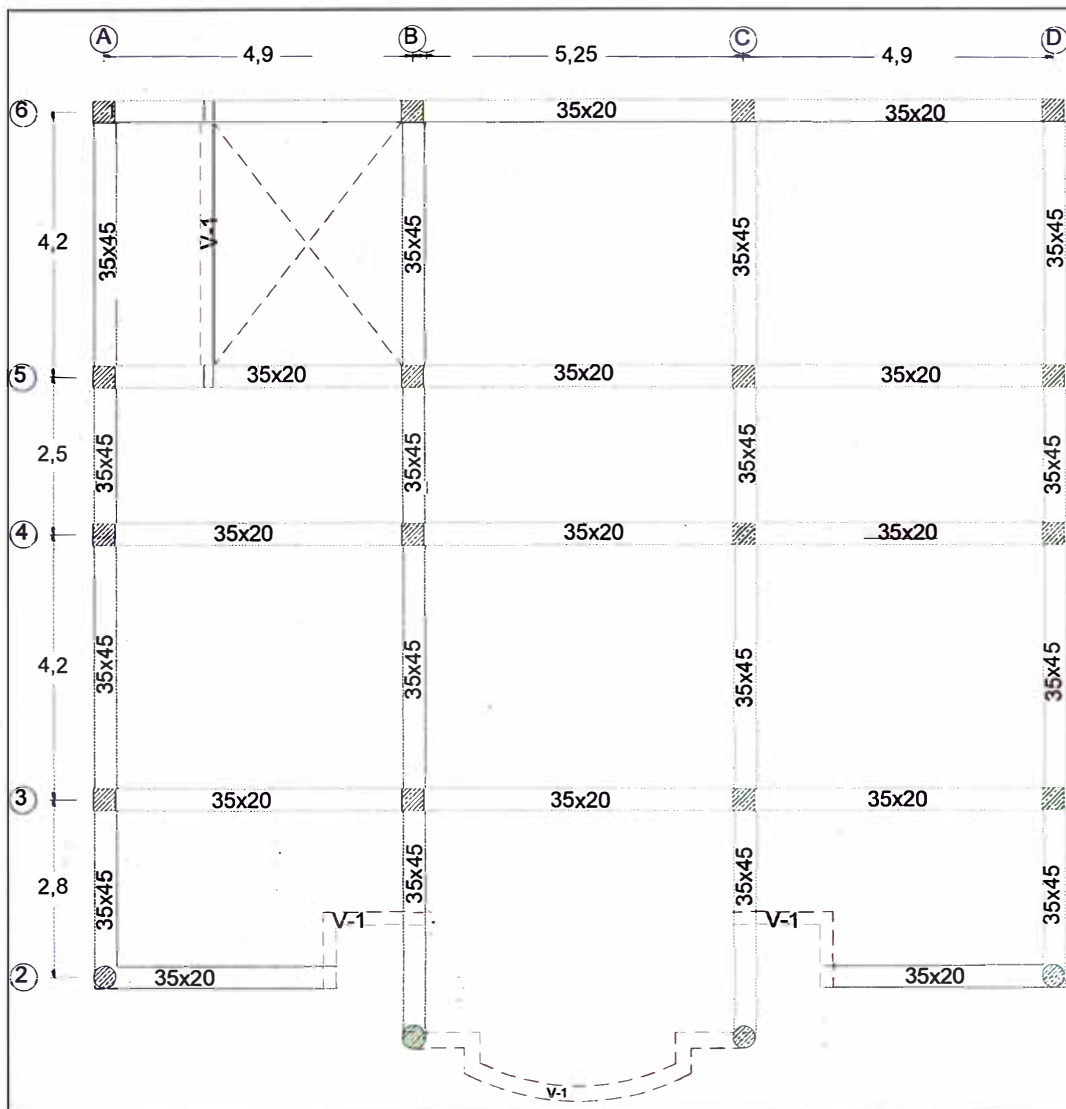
Planta tercer piso del edificio municipal – elementos estructurales
